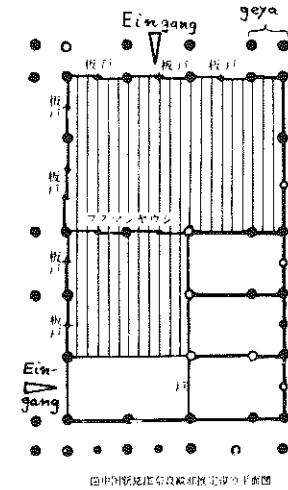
Grundrisse zweier Bauernhäuser aus der Präfektur Okayama um 1460.
